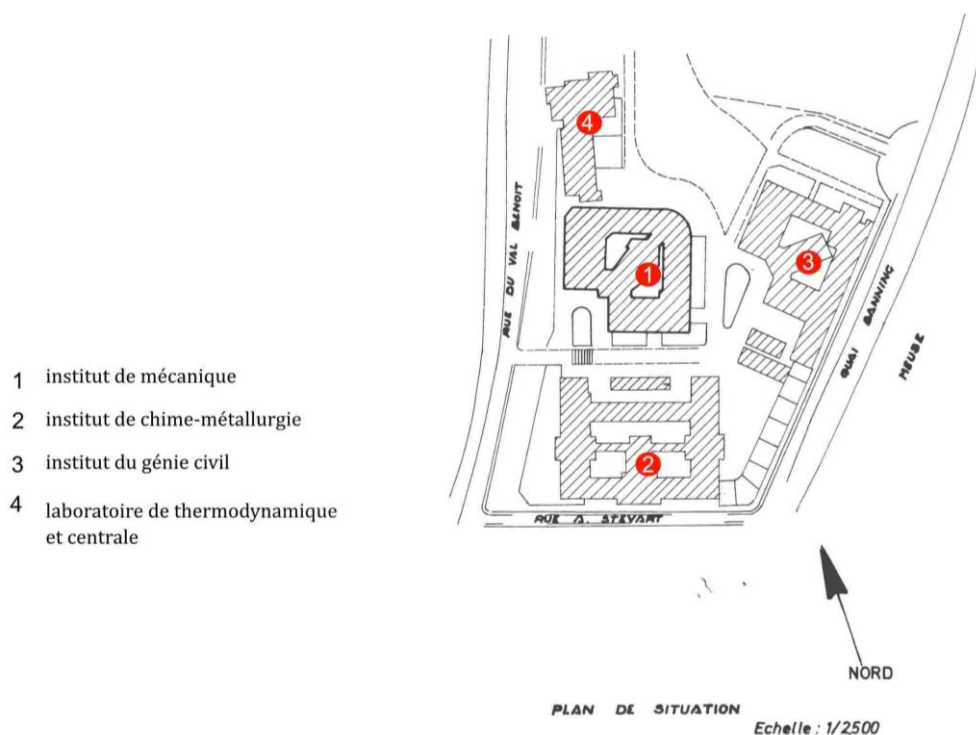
Plan de situation institut de mécanique (Sce. Entretien, 1979)
